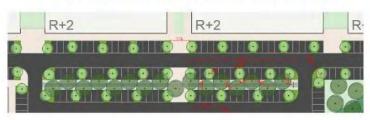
Séquence de plantation sur des aires de stationnement en façade commerciales lot 15. (axe Est<>Ouest)
